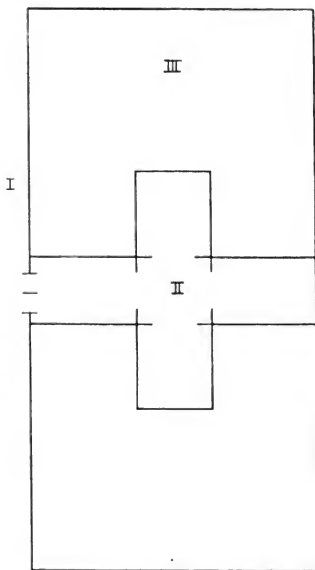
Scheune vom Grundriss des Klosters St. Gallen.
